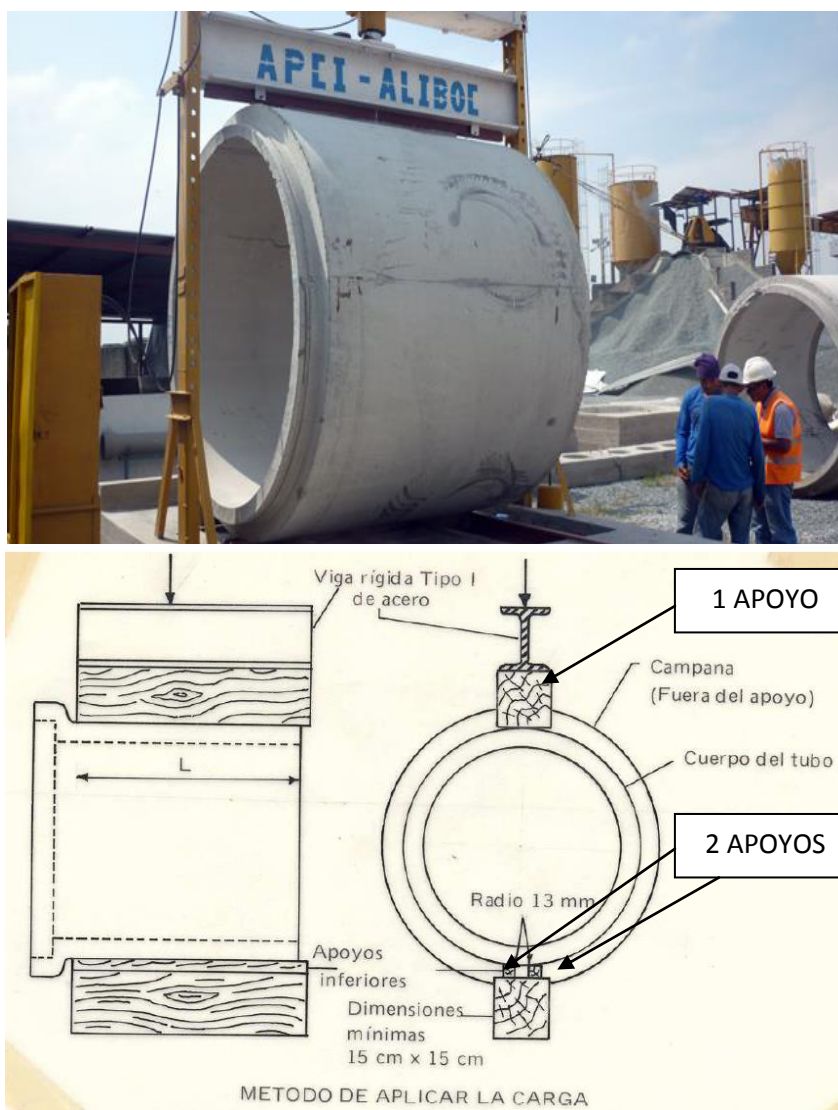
Ensayo de los tres apoyos realizados a las tuberías de 60"
